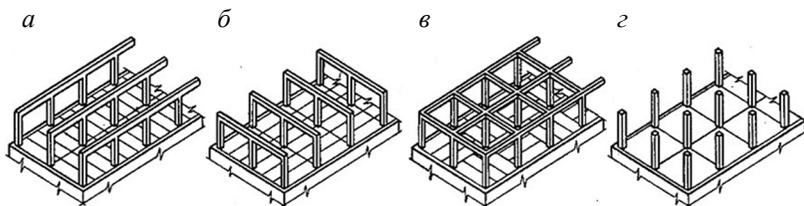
Конструктивные схемы каркасных зданий с расположением ригелей: *а* — продольным; *б* — поперечным; *в* — перекрестным; *г* — безригельная
